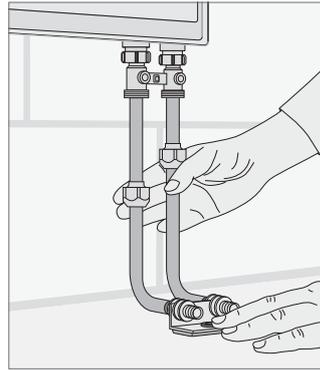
Posicionar el kit de codos de conexión a radiadores.
